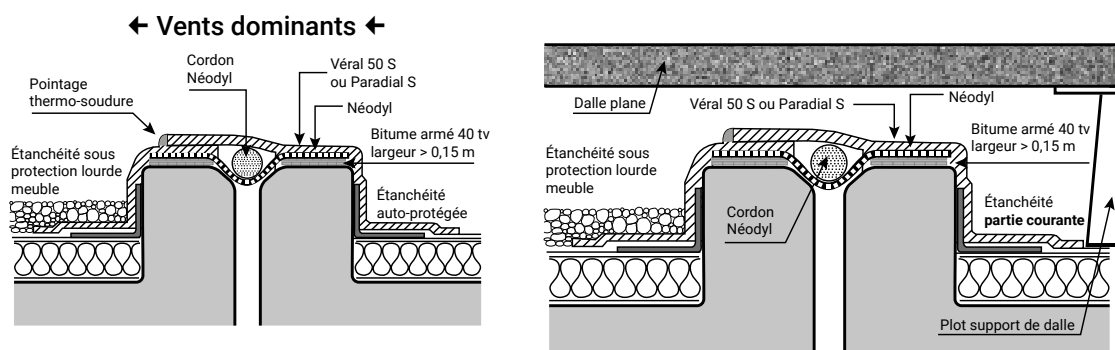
Joint de dilatation en pied de façade (NF P 84-204-1 et 2 [DTU 43.1]).
